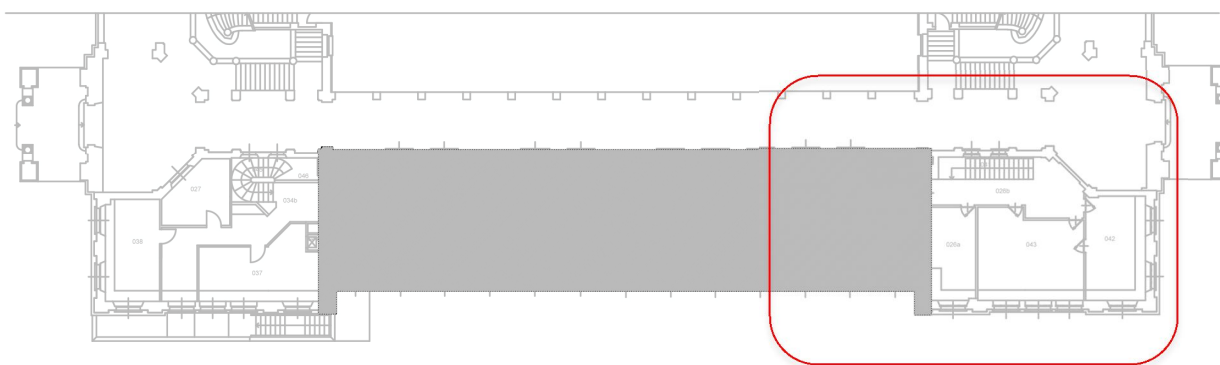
Ritaglio Pianta Piano Soppalco edificio 2 con segnalazione della zona interessata dal rilievo
